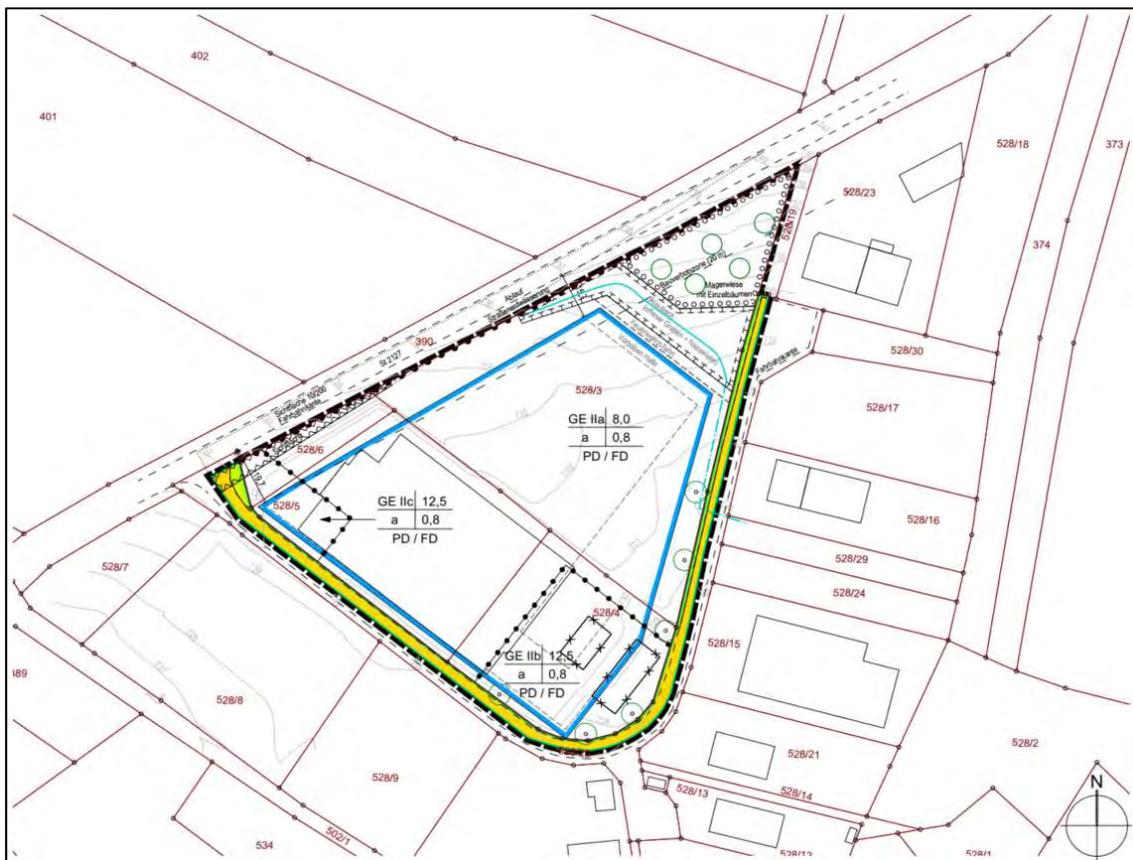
Lageplan mit Eintragung des geplanten Geltungsbereiches /14/
